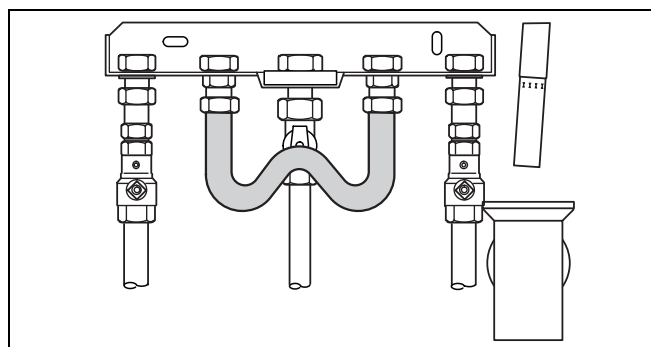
Raccordement des conduits – montage apparent avec by-pass U-KS
